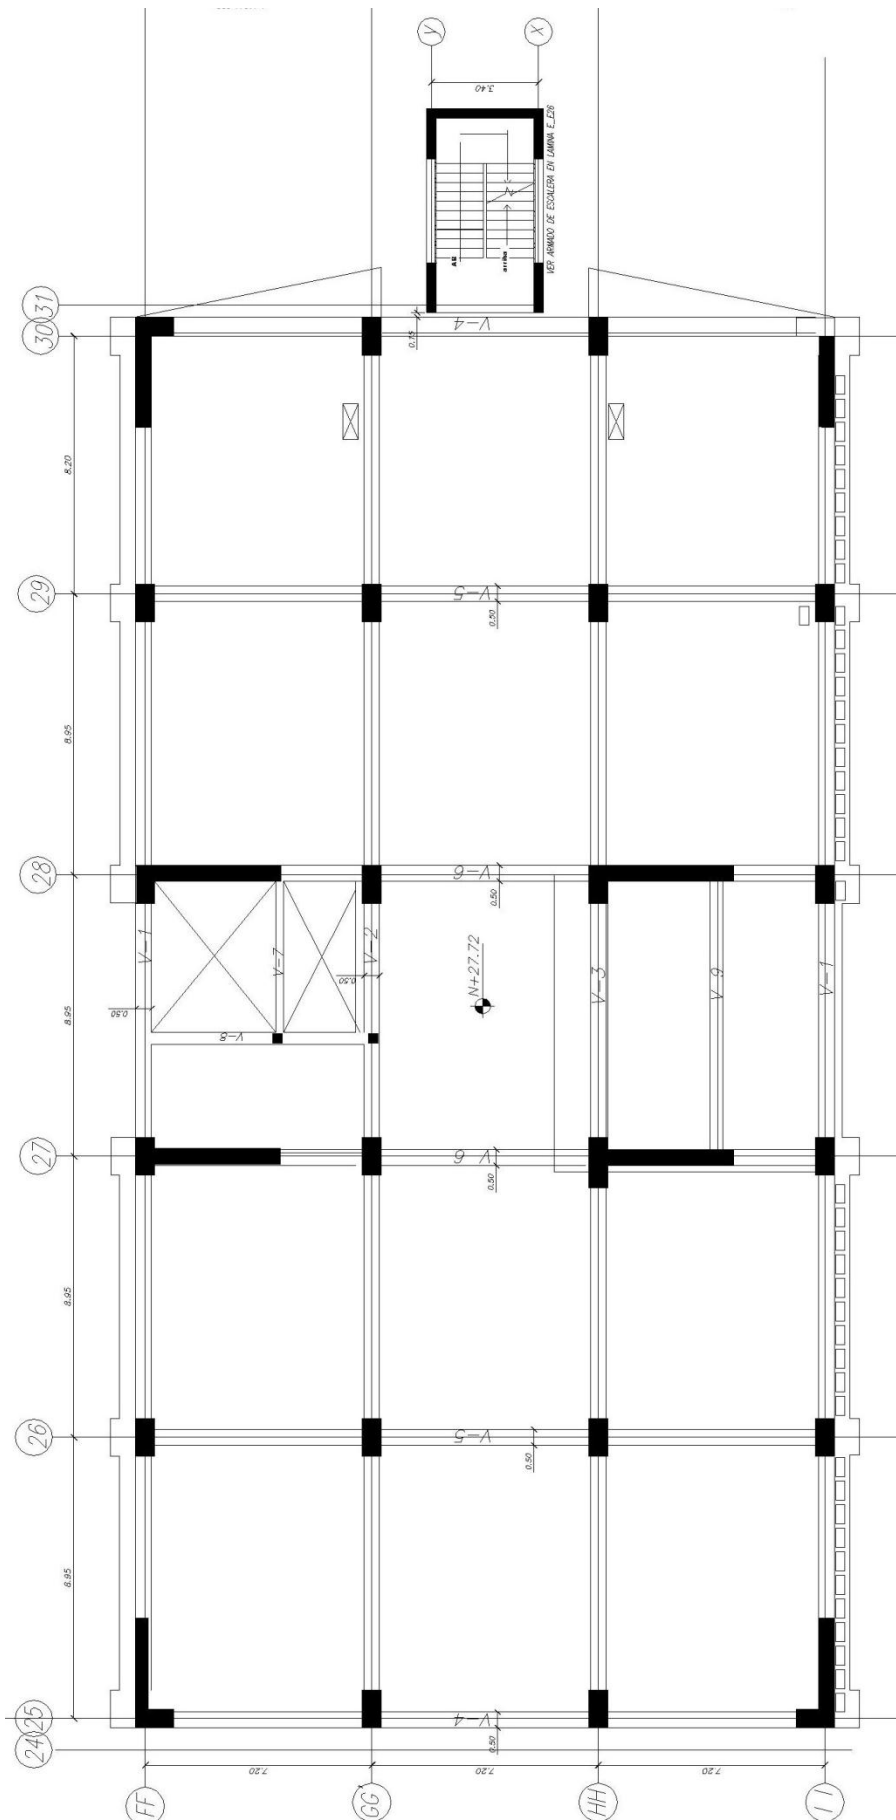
Planta Estructural Nivel: +27.72 m HOSPITALIZACIÓN
